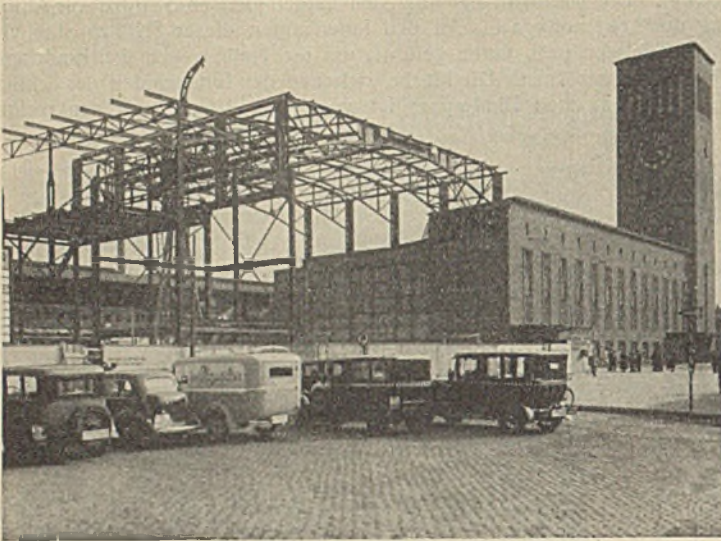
Neues Empfangsgebäude Düsseldorf. Stahlkonstruktion.
